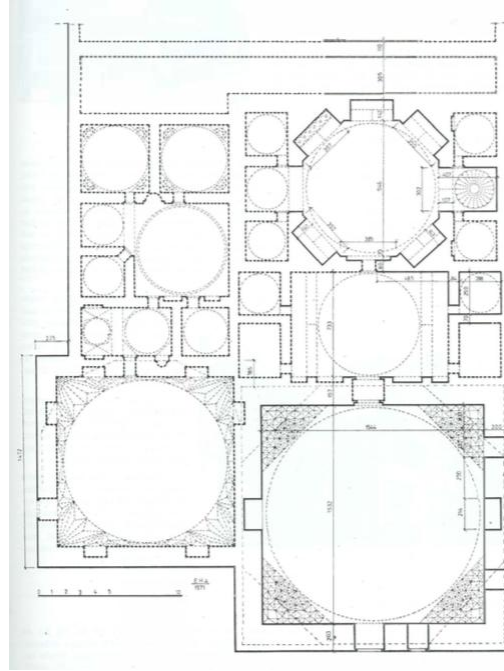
Kethüda Hamamı, planı (Önge, 1989)
